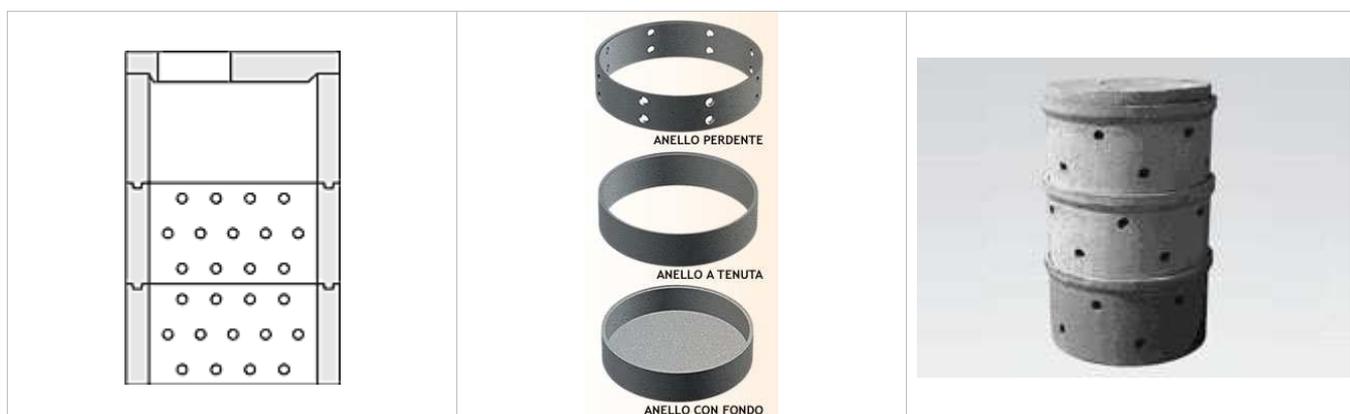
A - Parti prefabbricate per pozzi di dispersione
